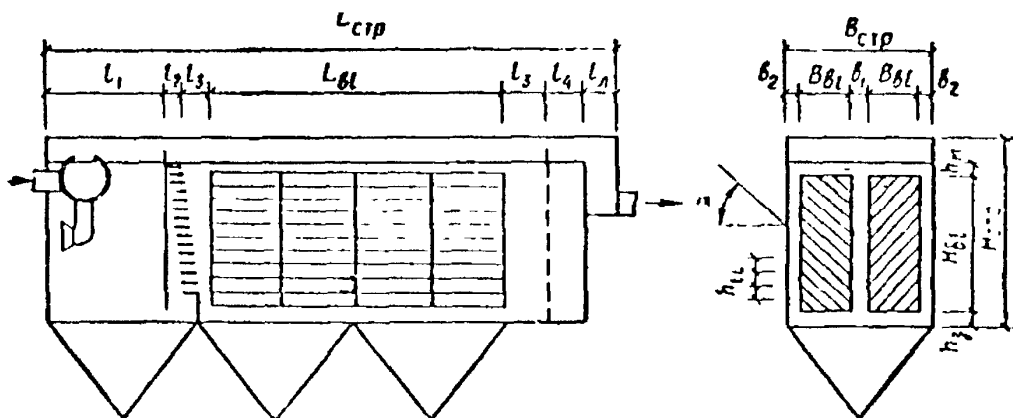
Схема тонкослойного отстойника, работающего по перекрестной схеме удаления осадка
